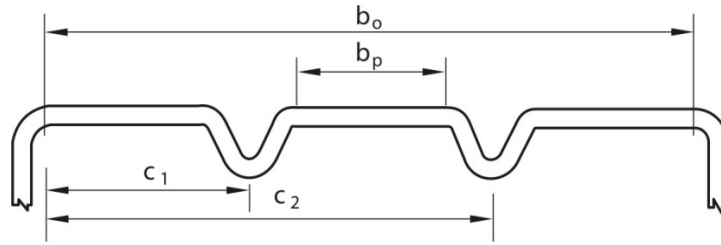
Anchos de placa (secciones planas) y ubicación de rigidizadores
